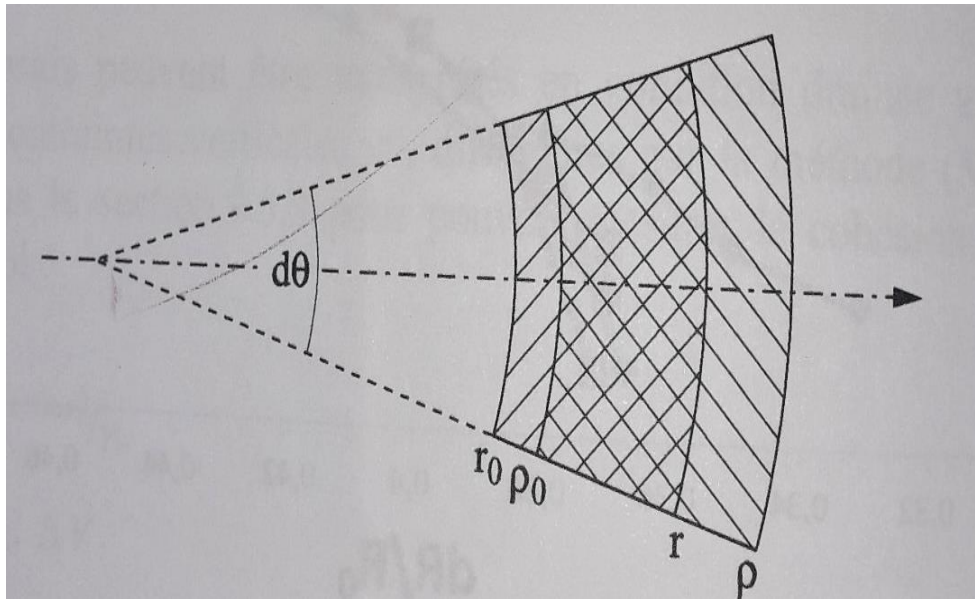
Déformation d'un secteur circulaire de sol dans le plan horizontal.
